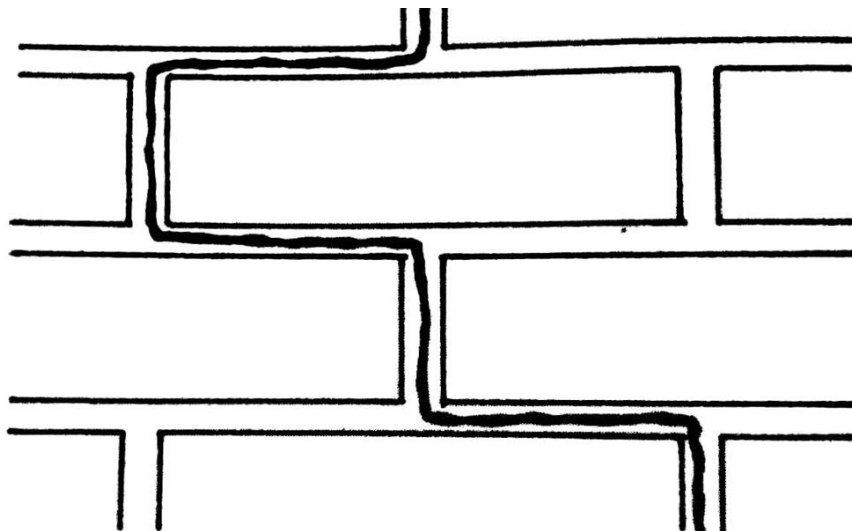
Fissura na alvenaria com desenvolvimento bastante irregular
